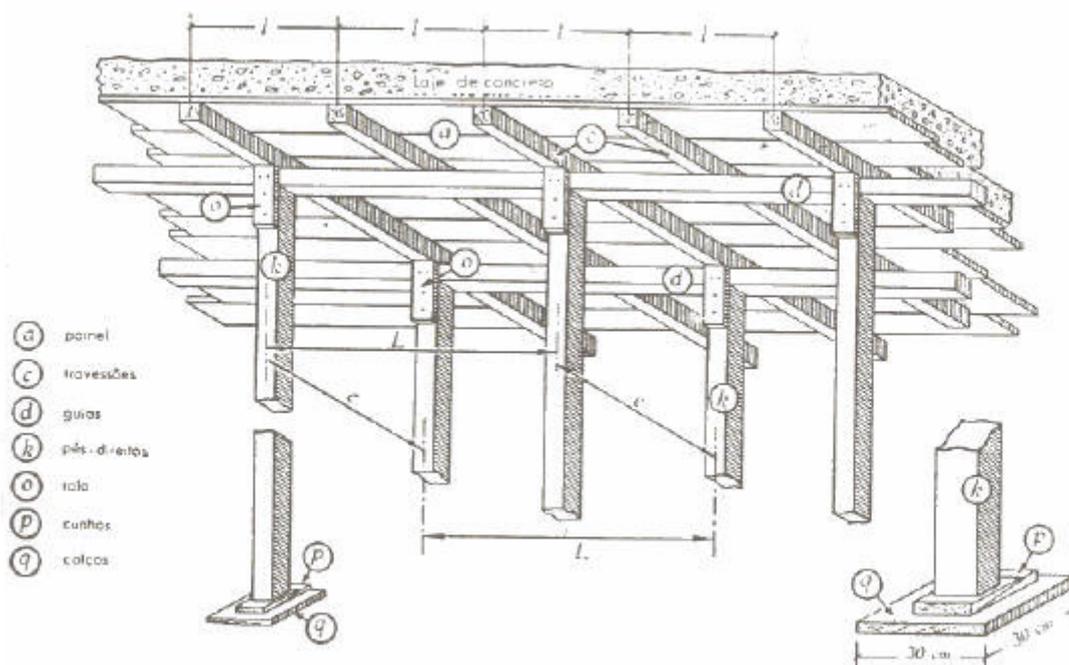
Fôrma de laje: tábuas apoiadas sobre travessões e apoiados por guias transversais.
